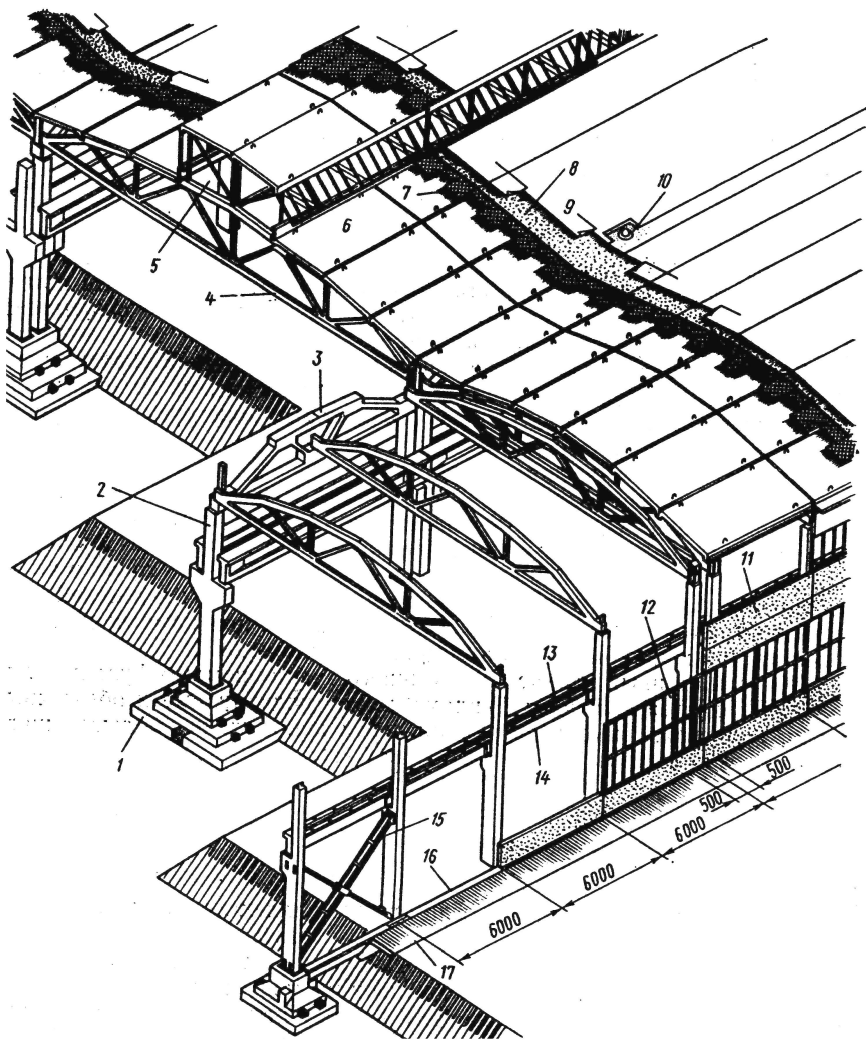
Железобетонный каркас одноэтажного здания: 1 – фундамент; 2 – колонна; 3 – подстропильная ферма; 4 – стропильная ферма; 5 – светоаэрационный фонарь; 6 – плита покрытия; 7 – утеплитель по пароизоляции; 8 – выравнивающий слой; 9 – кровельный ковер; 10 – воронка внутреннего водостока; 11 – стеновая панель; 12 – ленточное остекление; 13 – крановый рельс; 14 – подкрановая балка; 15 – связи; 16 – фундаментная балка; 17 – отмостка
